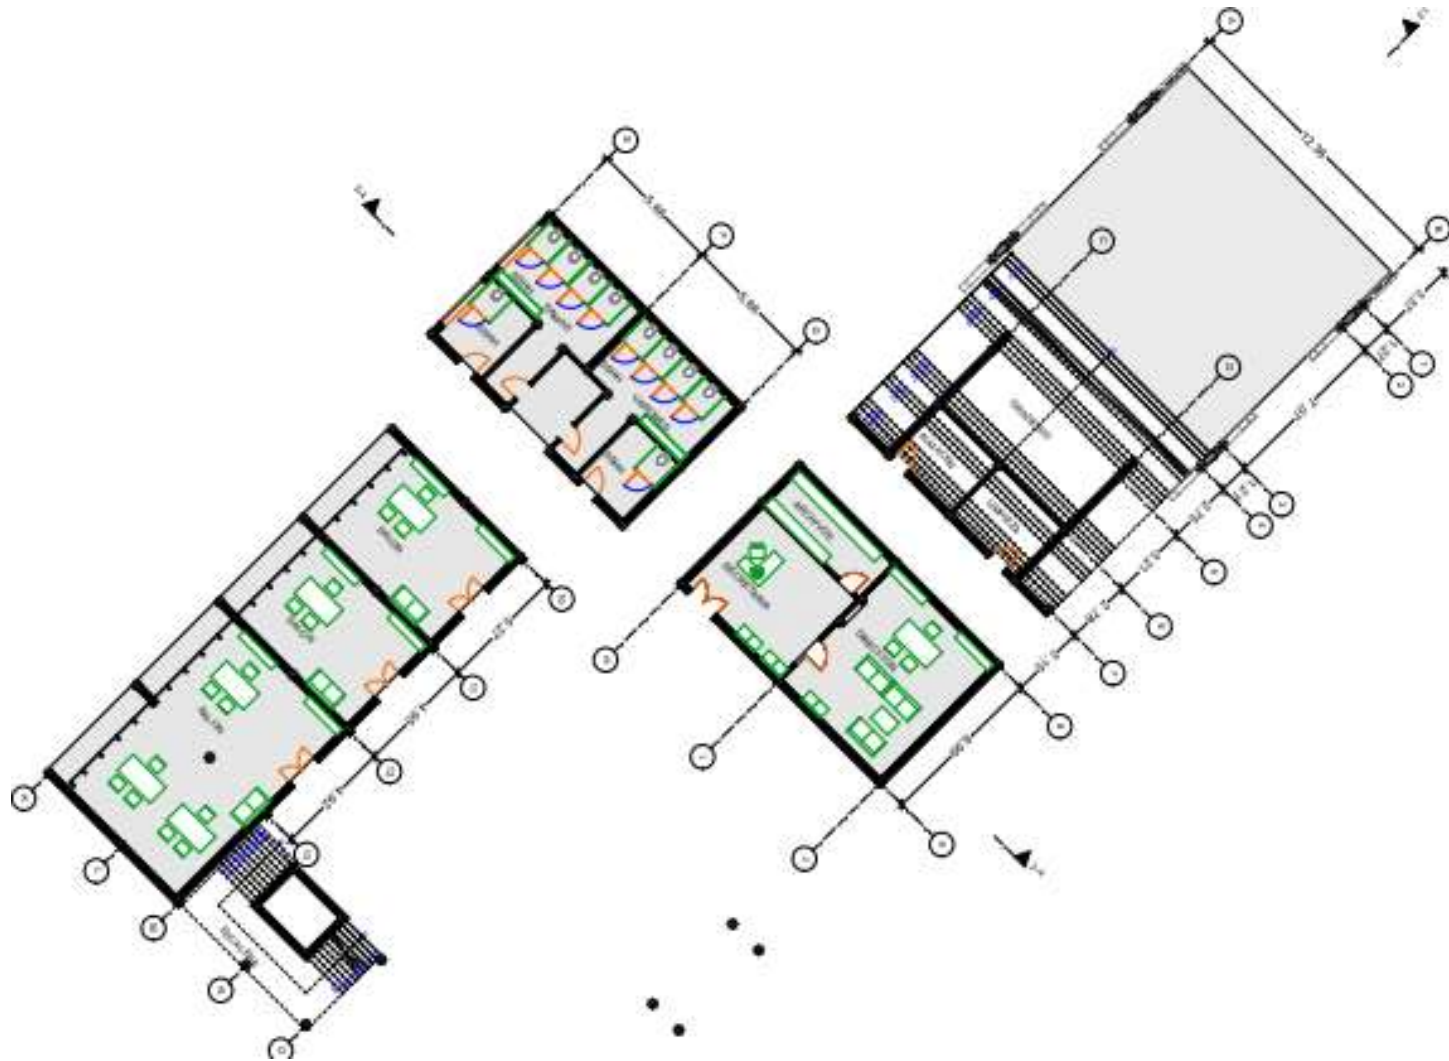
Plano en planta del Primer nivel de proyecto – Bloque 1
